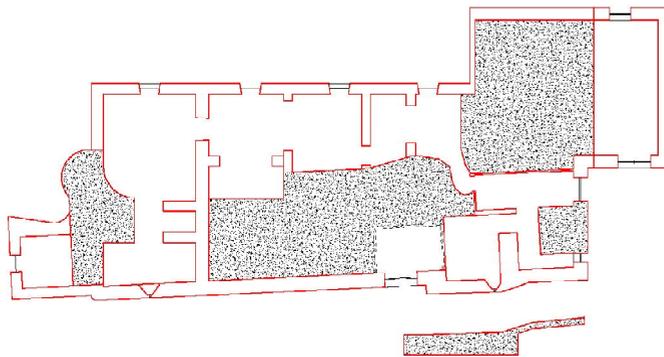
Possibile 3^a fase di costruzione dell'ospitale: pianta e prospetto.
